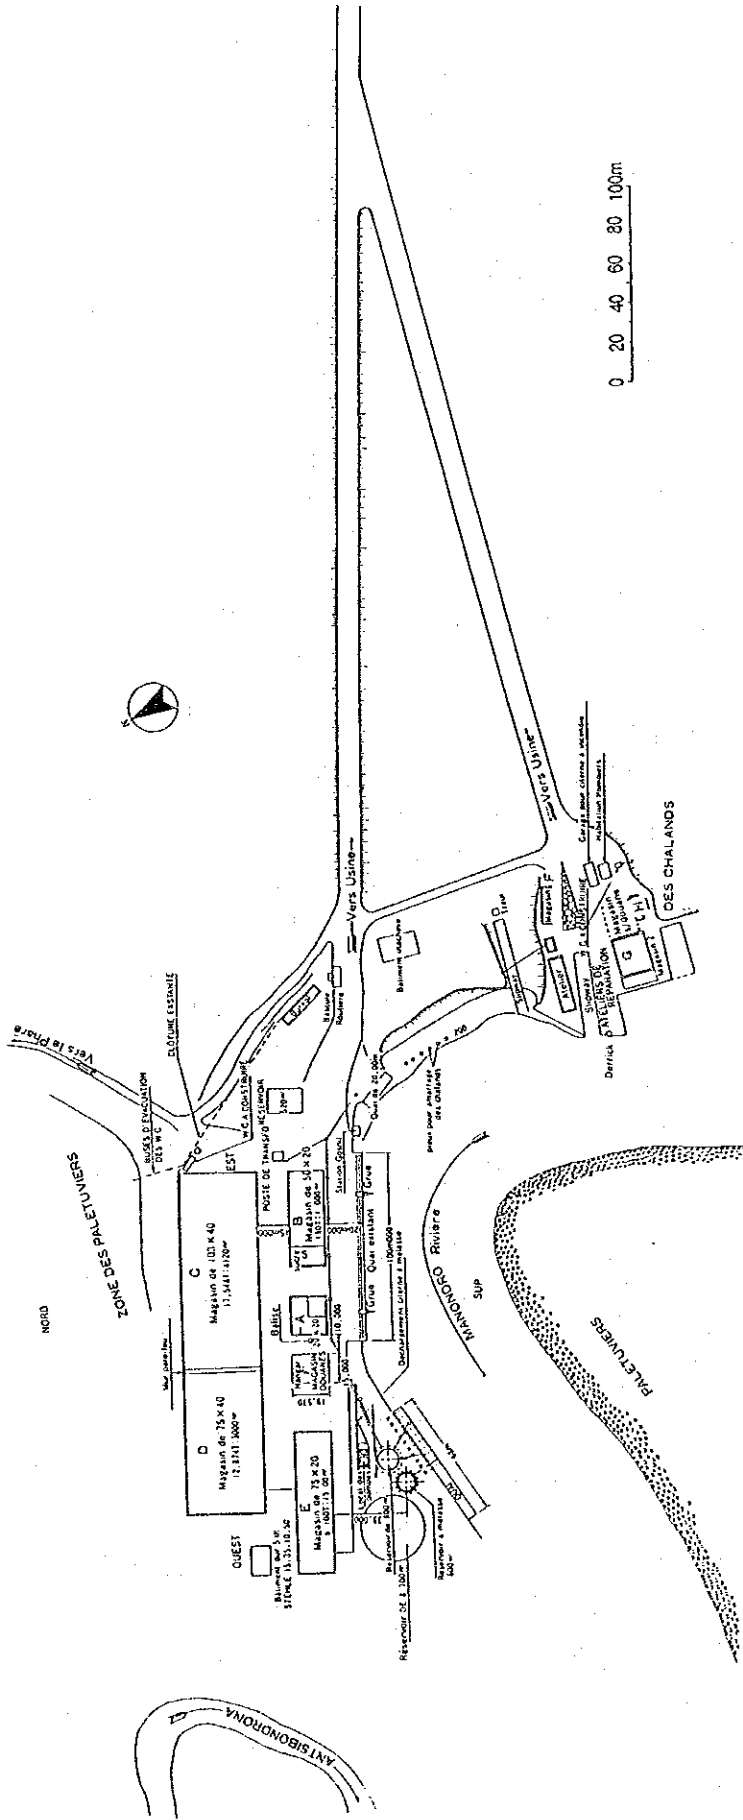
Plan d'Implantation du Port SAINT LOUIS
